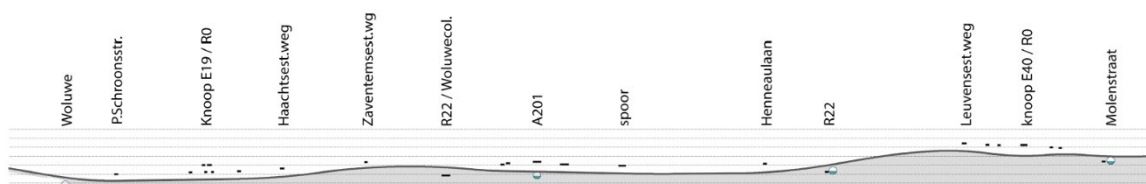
Profil longitudinal existant dans la zone de Zaventem
